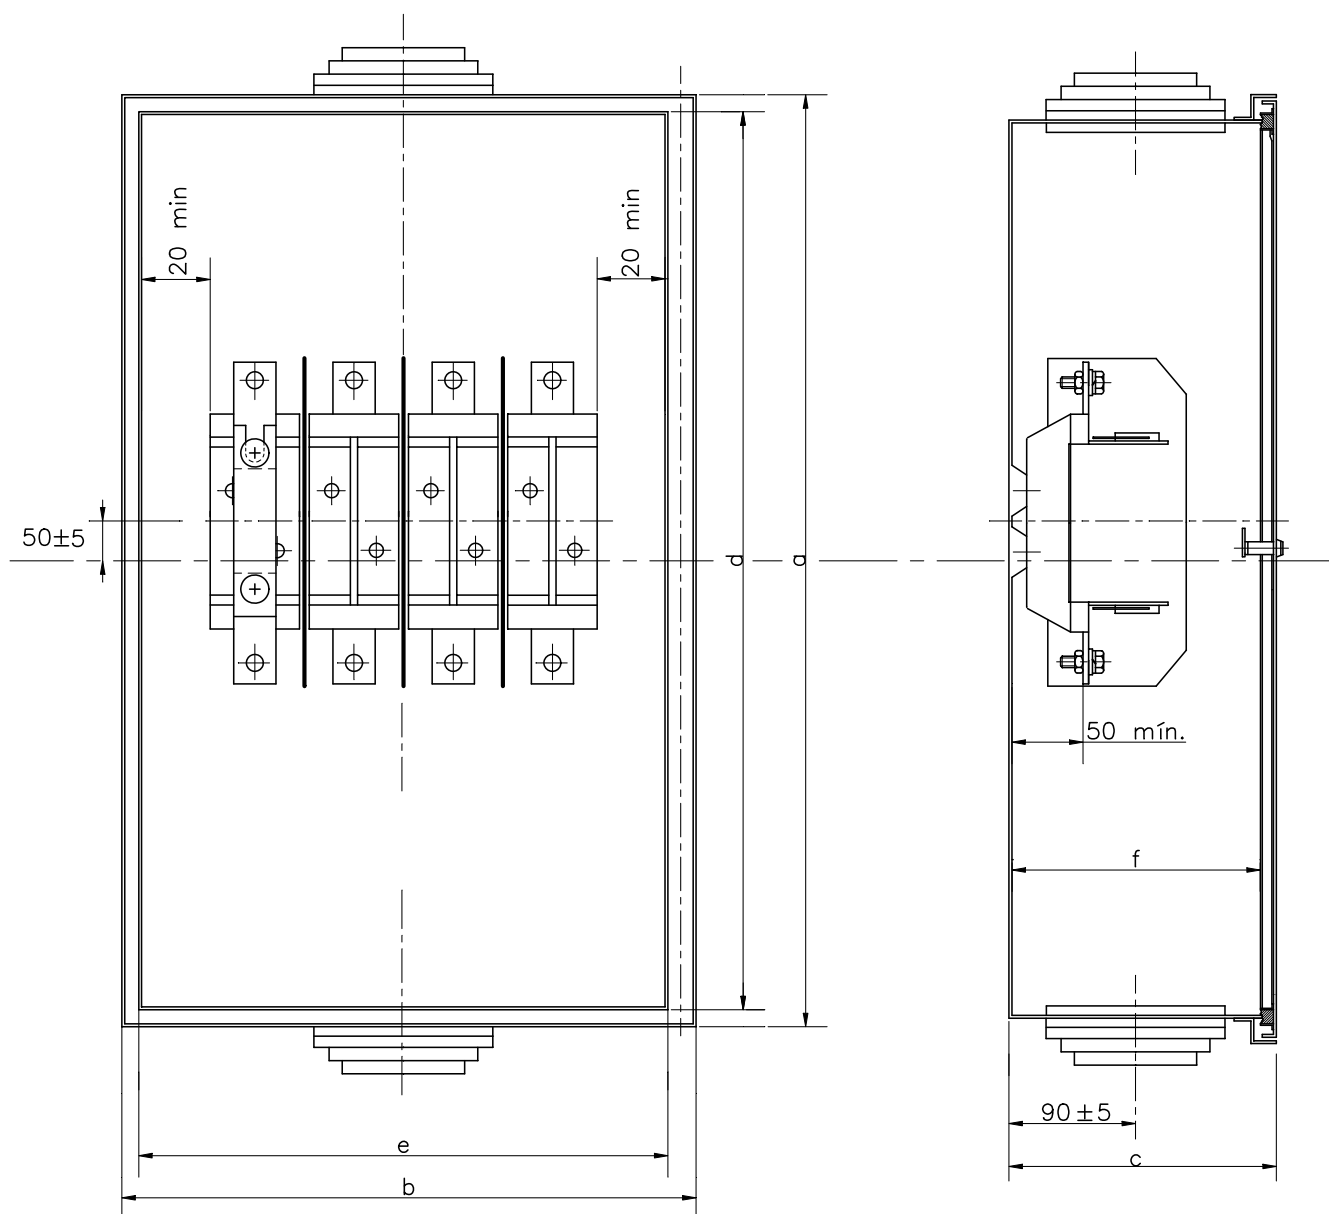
Portinhola P400 – Disposição e dimensões
